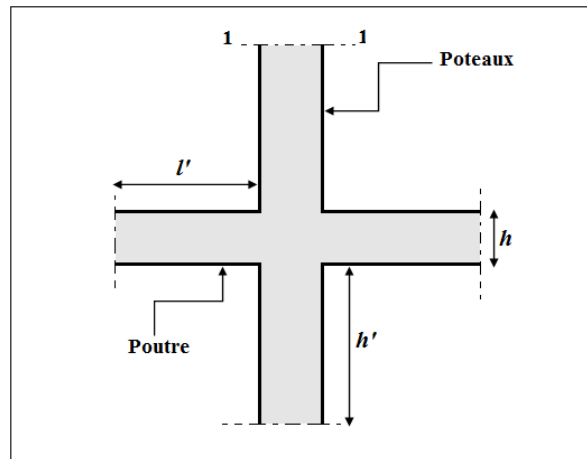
Zone nodale (nœud poutre-poteaux)
